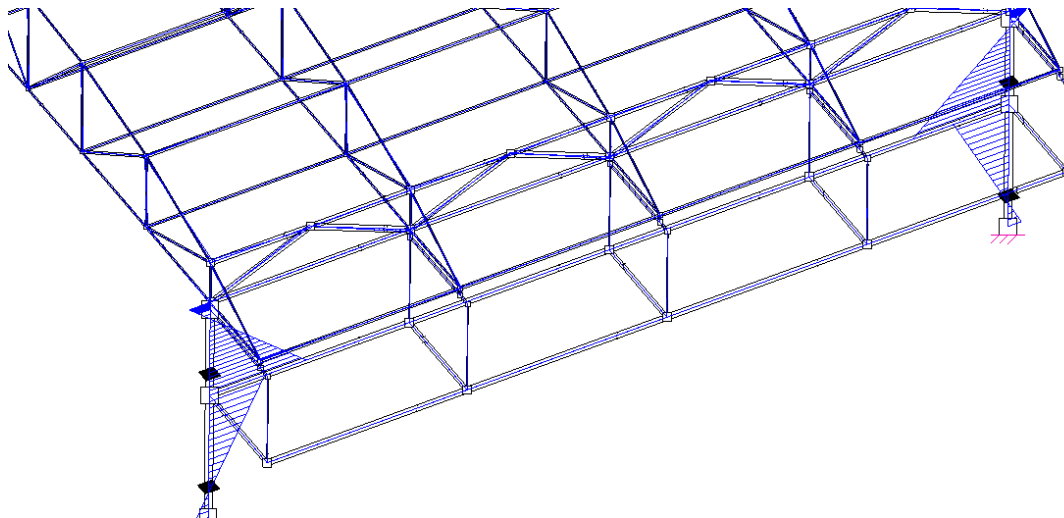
Detalle del diagrama de momentos flectores en Y sobre las columnas para el caso de carga más desfavorable.
